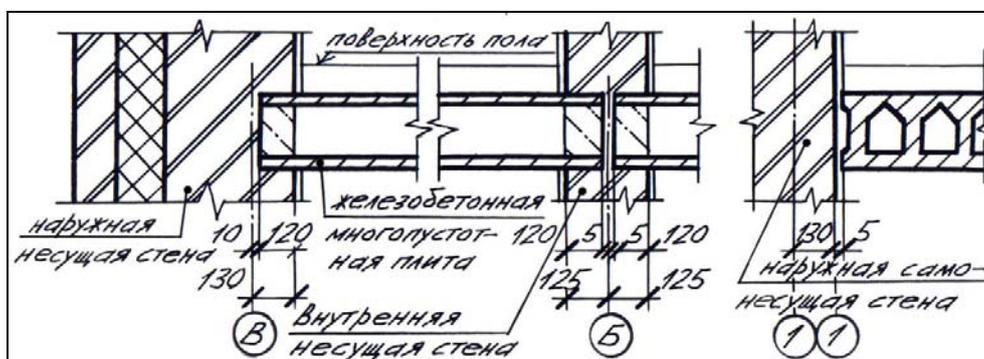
Привязки в случае междуэтажного перекрытия из сборных многпустотных железобетонных плит
